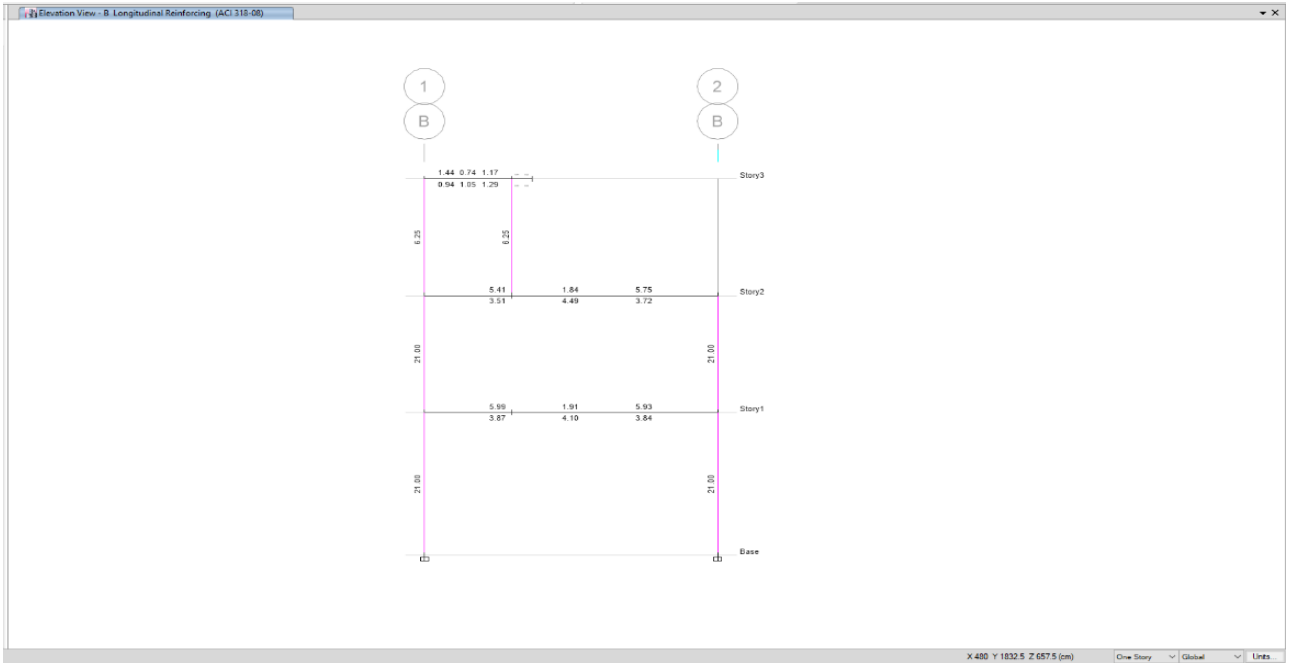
Plano del diseño de acero en columnas – Pórtico 2 - 2
